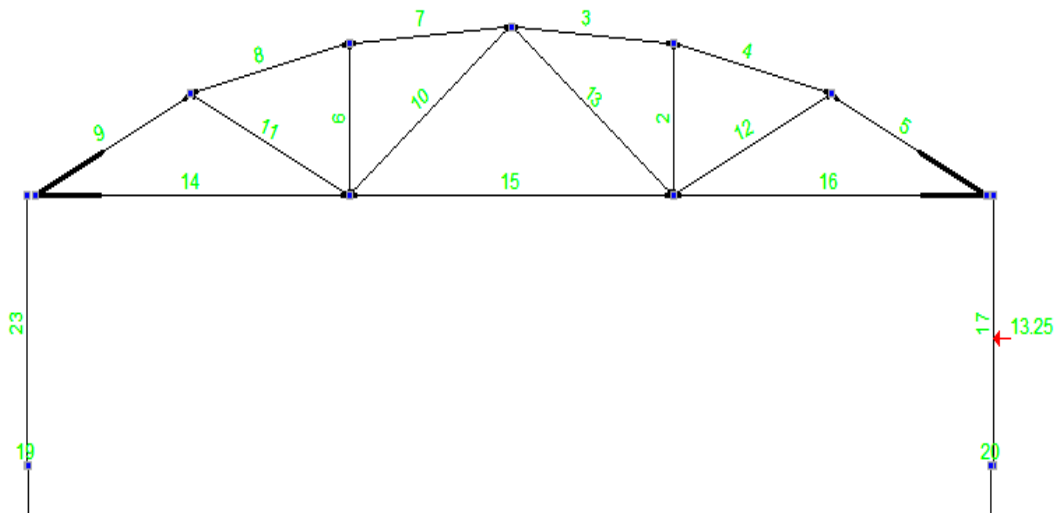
Расчетная схема после задания нагрузок загрузки б
